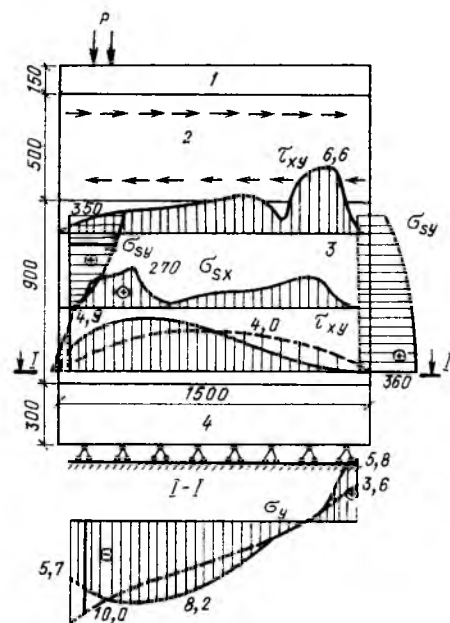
Эпюры напряжений в образце из легкого бетона с полевым армированием 0,05 % и контурной арматурой
